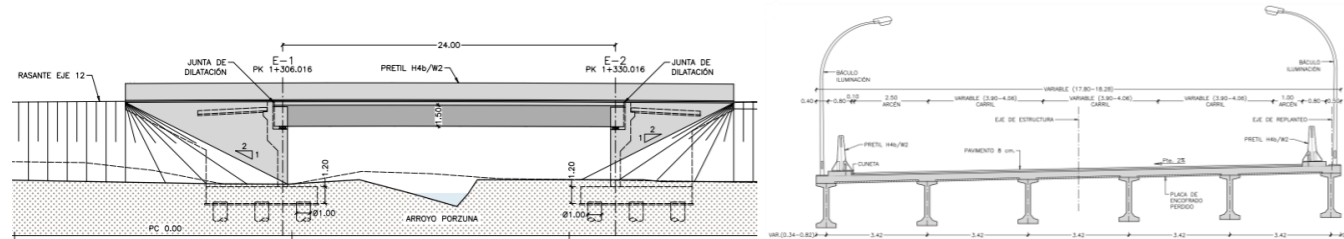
Estructura E-5a. Alzado y sección transversal tipo
